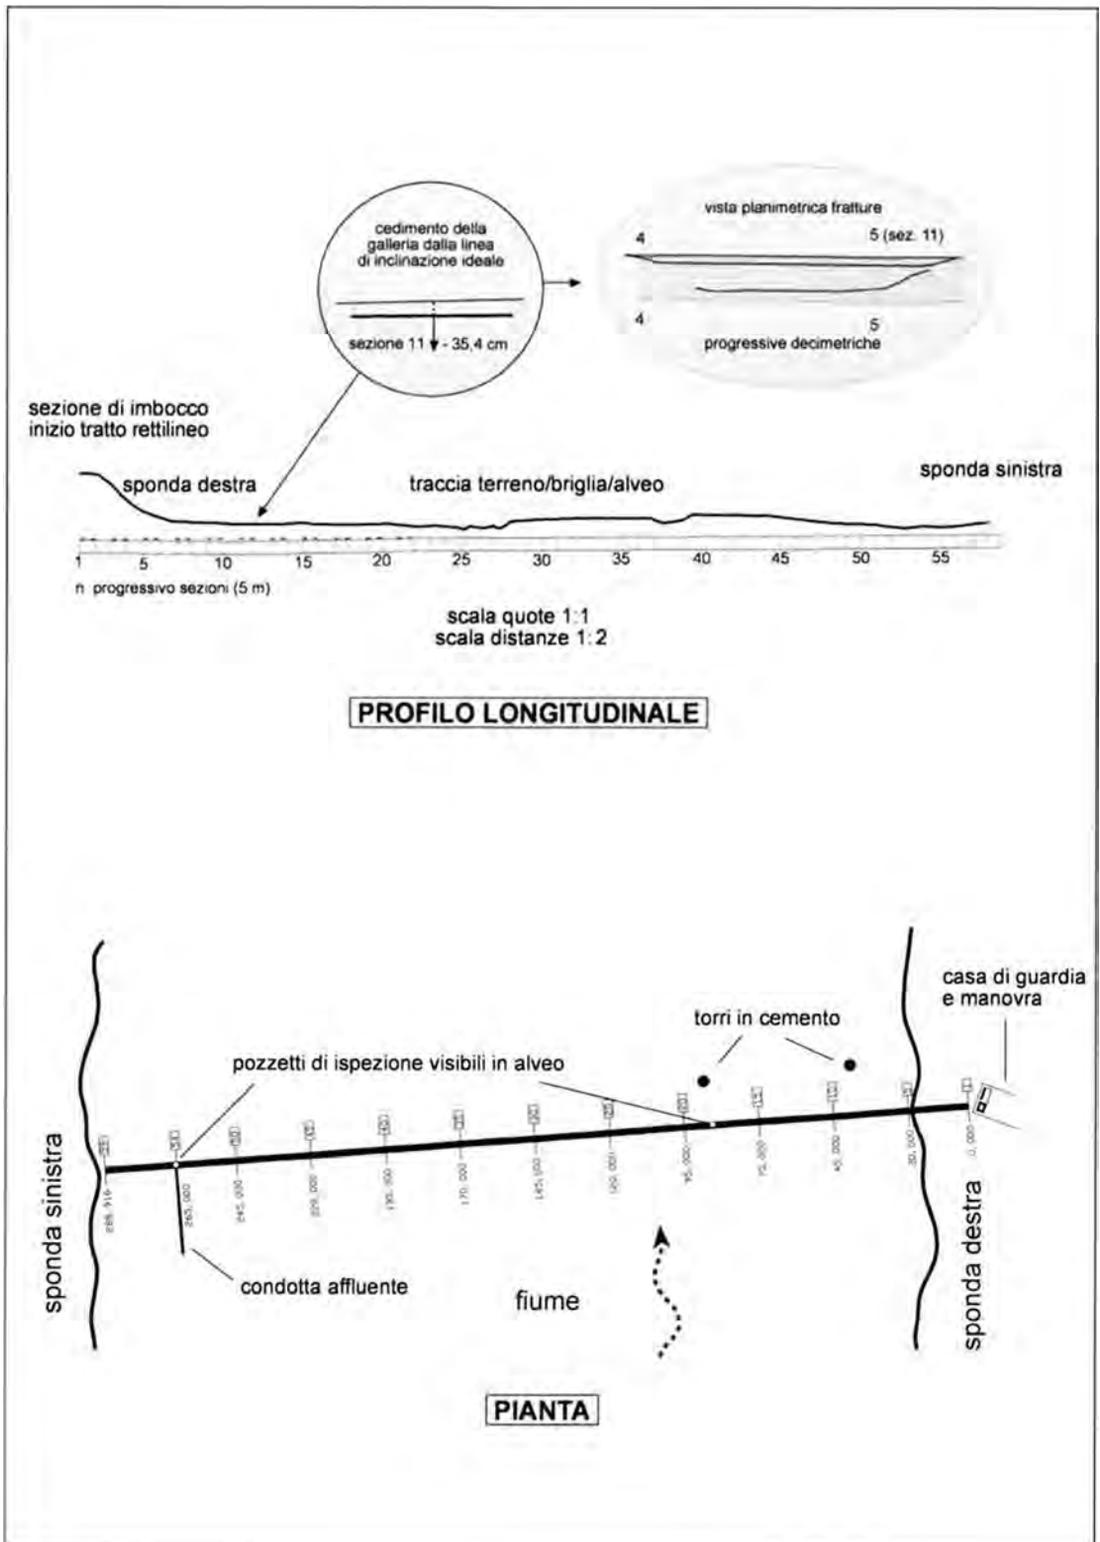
Pianta e sezione del Traversante di Trebbia (grafica M. Chiesi).
